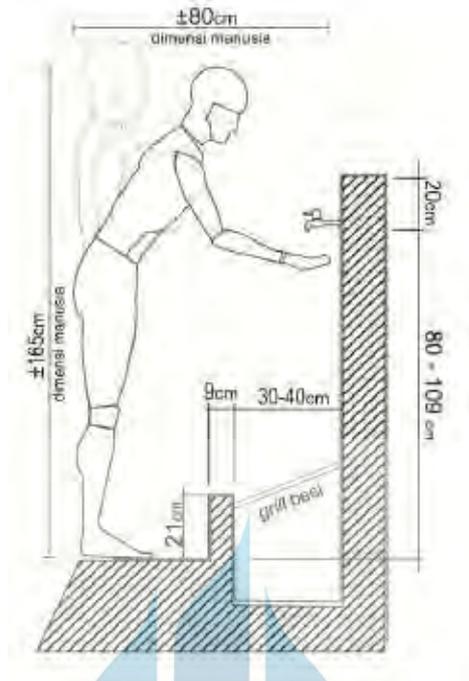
Potongan Ruang Wudhu Berdiri (sumber: Suparwoko, 2016)
